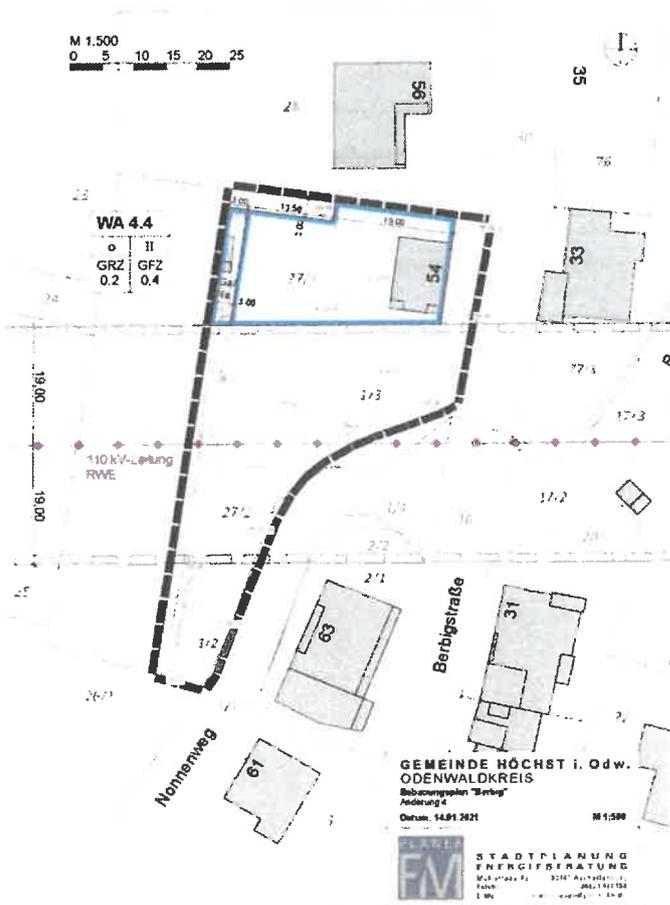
Übersicht über das Baugrundstück, der Bereich der geplanten Bebauungsplanänderung ist blau markiert
